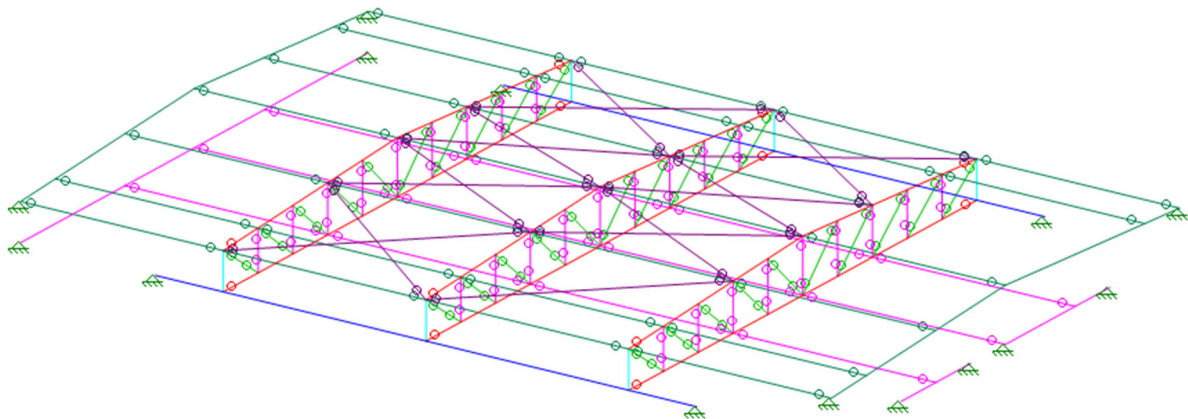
VISTA 3D COBERTURA BLOCO LIGAÇÃO
